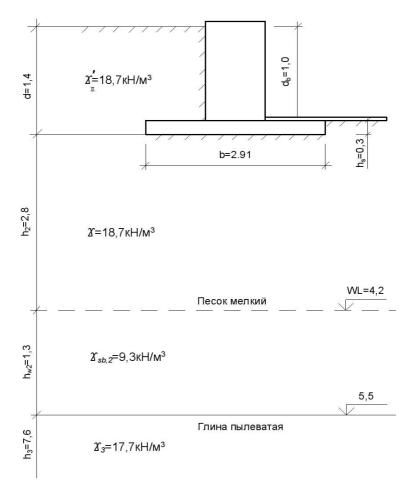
Схема расположения фундамента мелкого заложения в грунтовом массиве
